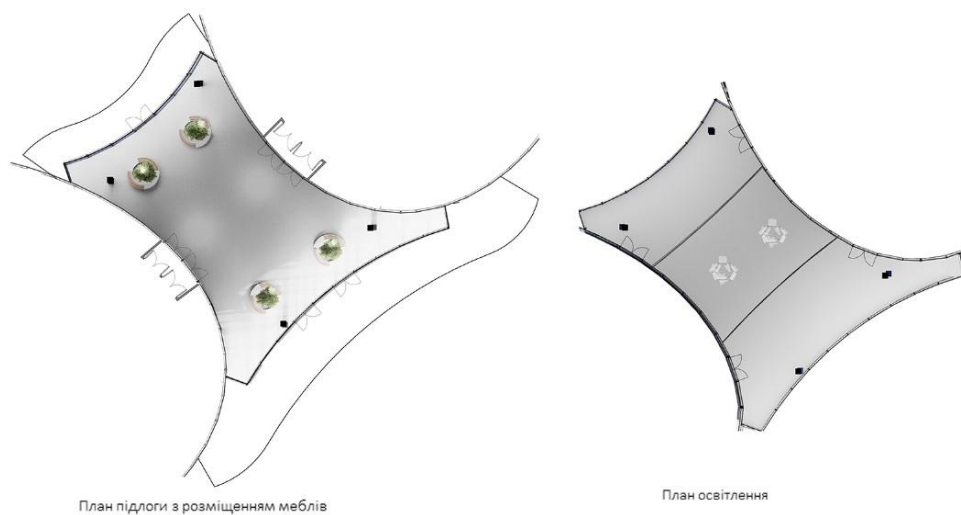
план підлоги з розстановкою обладнання та план стелі з розстановкою світильників
